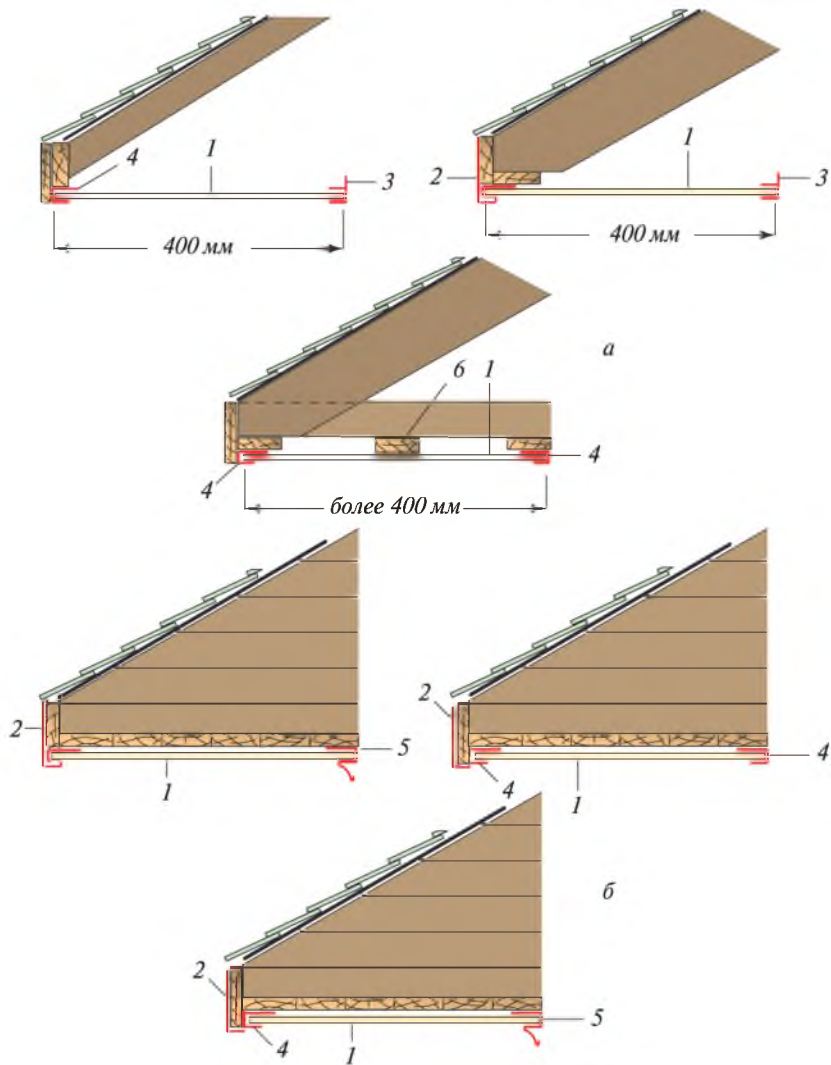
Варианты крепления софмитов: а — на открытом свесе крыши; б — на закрытом свесе крыши; 1 — софмит; 2 — J-фаска Döcke (целая или разрезанная); 3 — прижимной профиль (изготавливается из J-профиля); 4 — J-профиль; 5 — молдинг Döcke; 6 — дополнительный брусок
